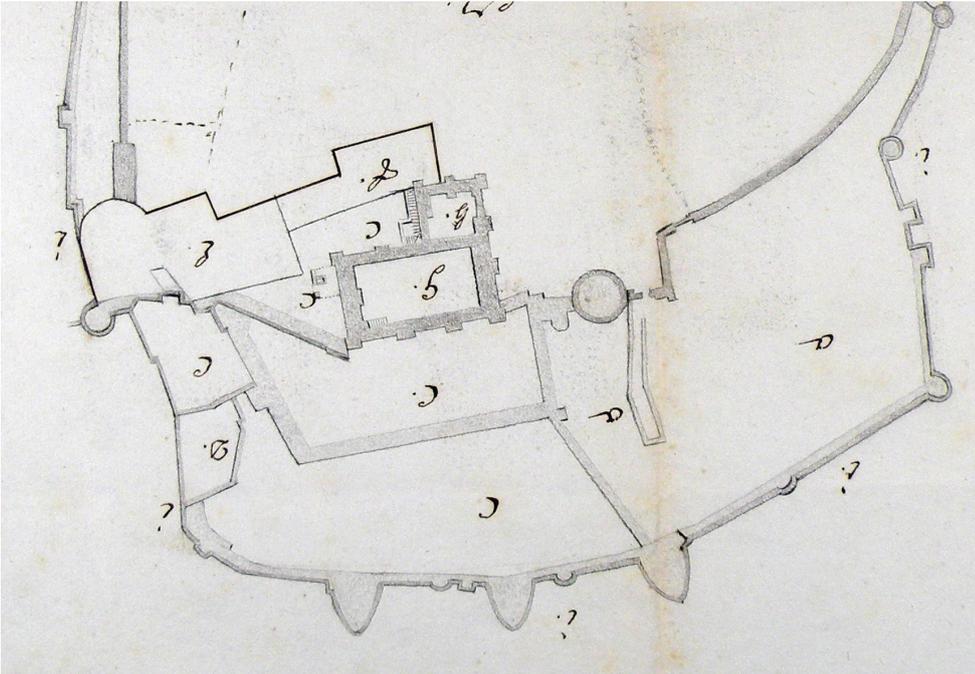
détail du plan de 1810 (ADIL 4N99)
